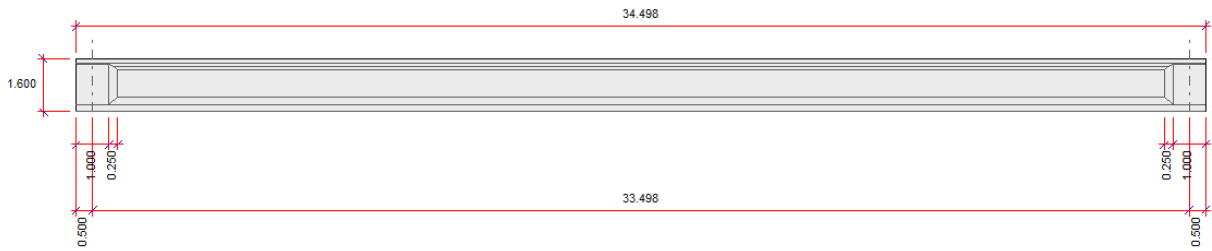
Alzado de viga. Fuente: IDOM-DEHC.
